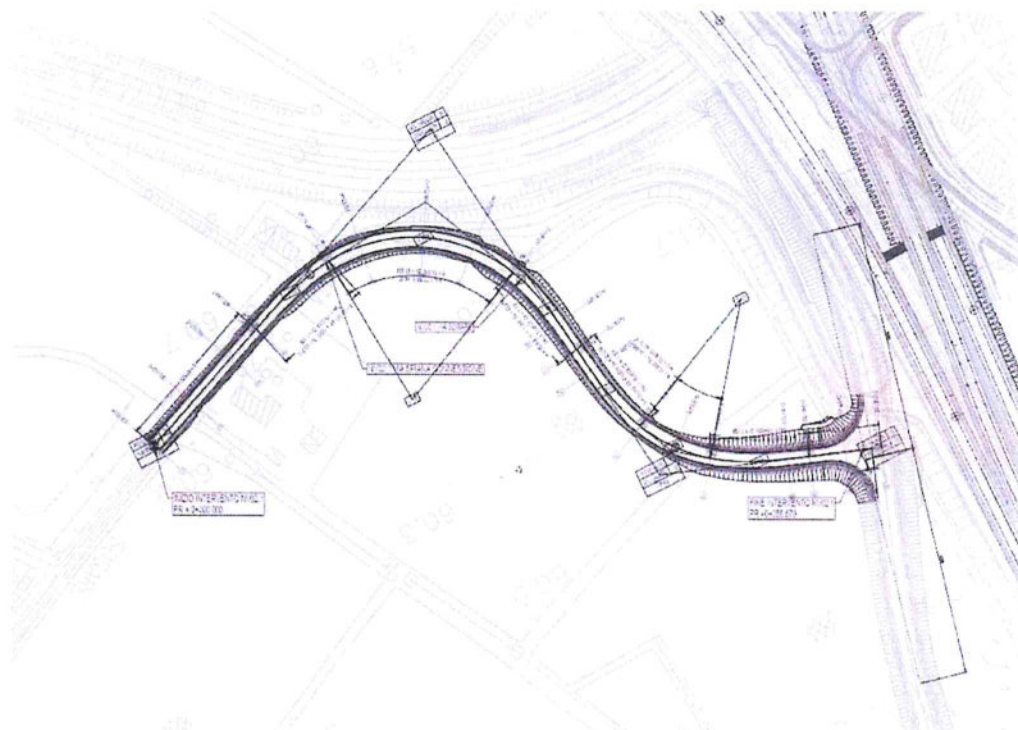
NV02.1 – Stralcio planimetrico su rilievo Via Sogare
